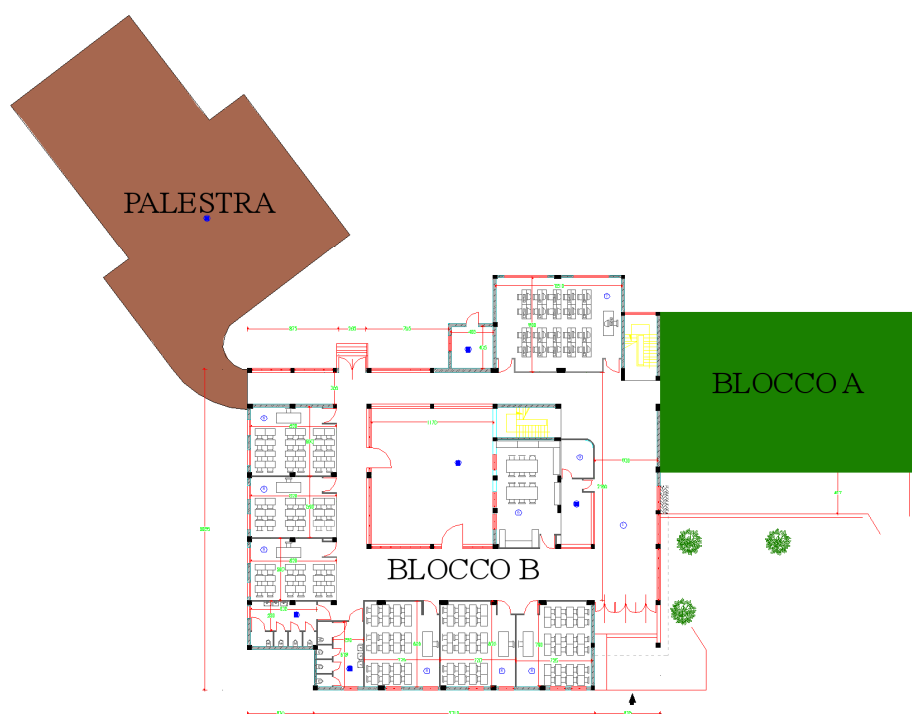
Pianta generale del complesso scolastico "Adolfo Omodeo" ed individuazione dei blocchi di fabbrica
